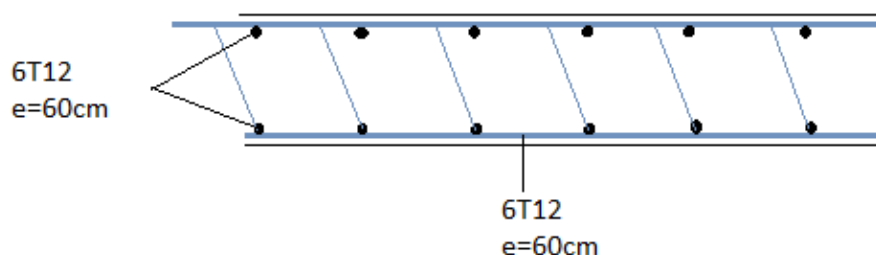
Coupe horizontale du ferrailage du voile périphérique.
